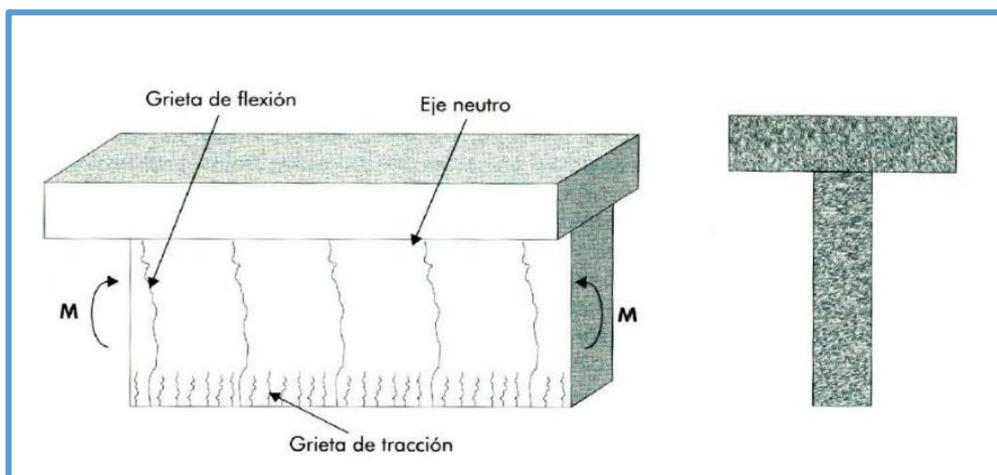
Grietas por flexión y tracción de un elemento sometido a esfuerzo de flexión.
